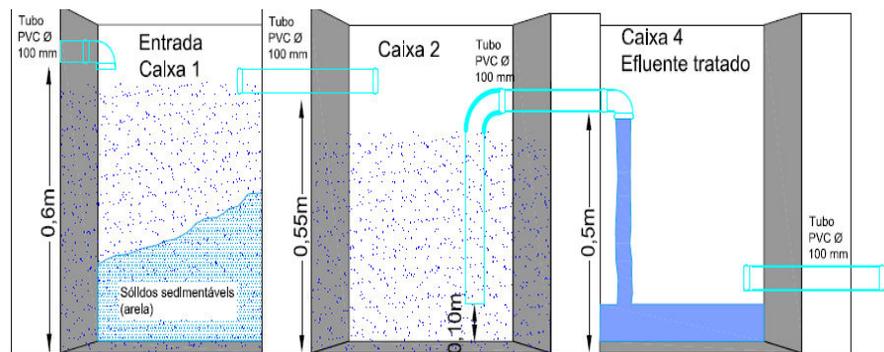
Corte Longitudinal de um Sistema Separador com Vista do Efluente Tratado
